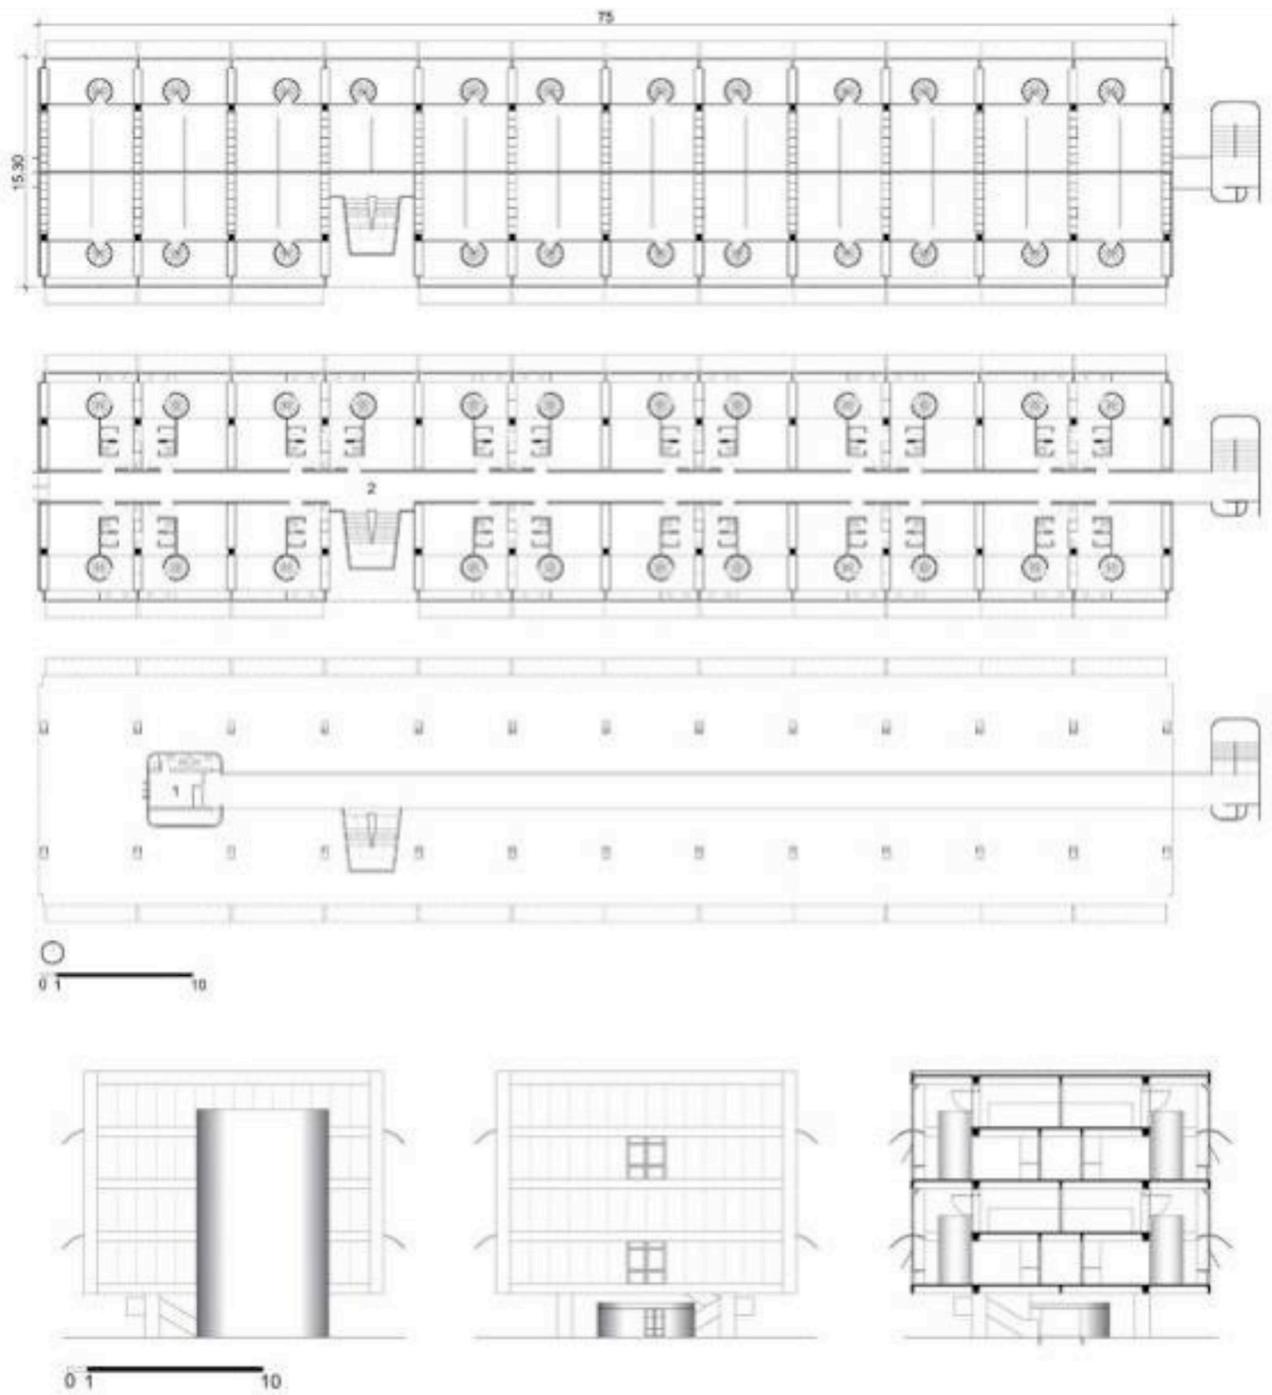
Habitação estudantil UnB. Plantas baixas, cortes e fachadas.
